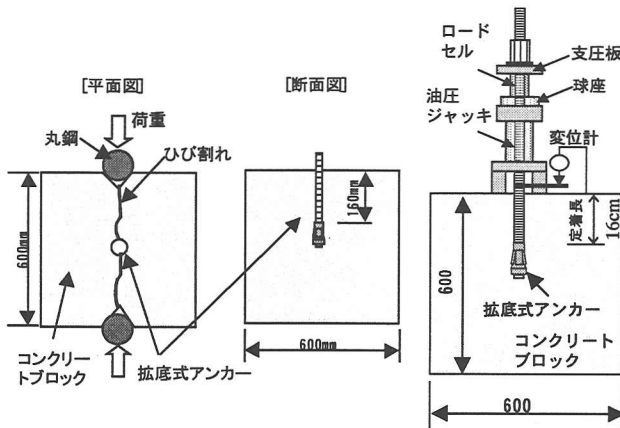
ひび割れ導入方法と引き抜き試験方法
